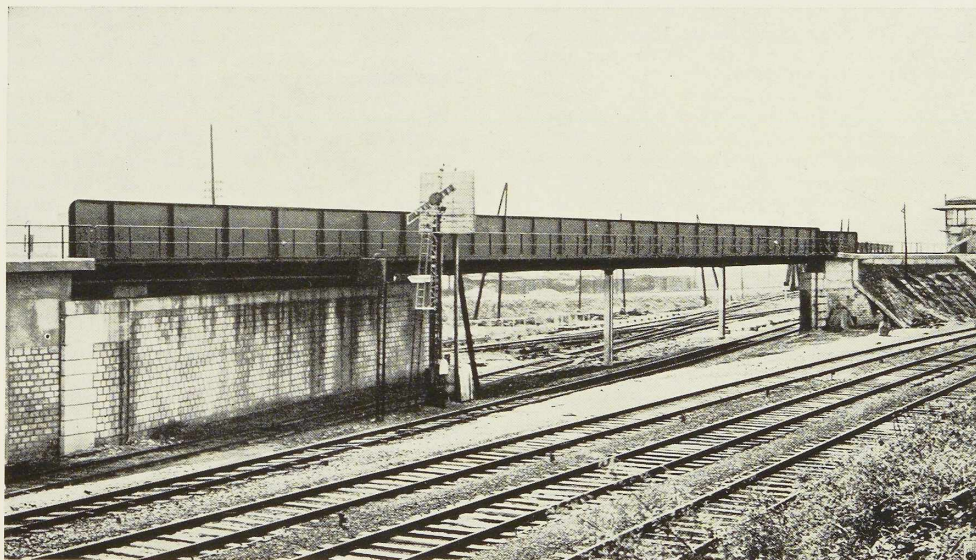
Vue générale du pont-rail soudé de Saint-Denis.
